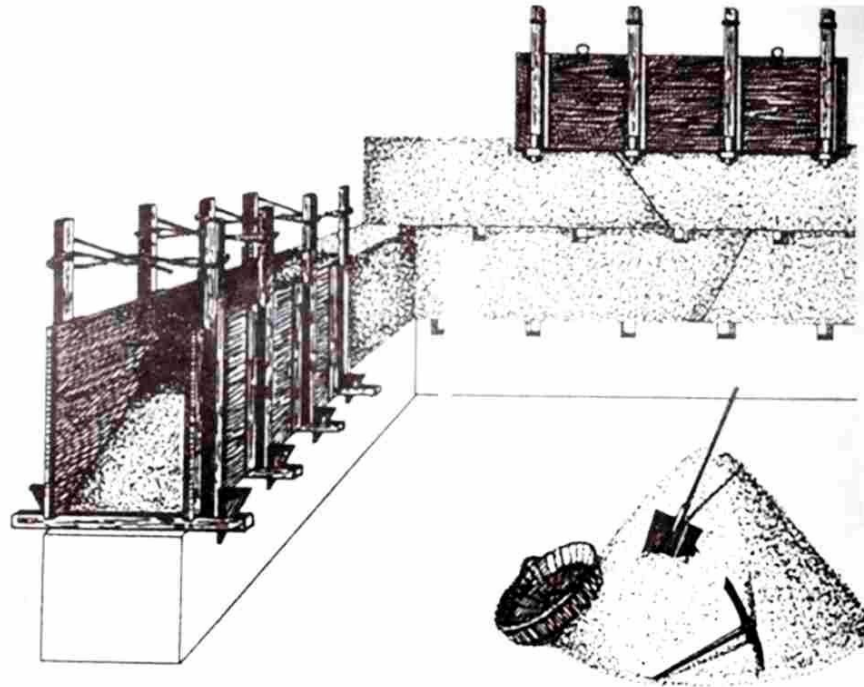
Proceso constructivo de muros de tapia pisada. Fuente: Construcción de muros en tapia y bahareque. SENA.
